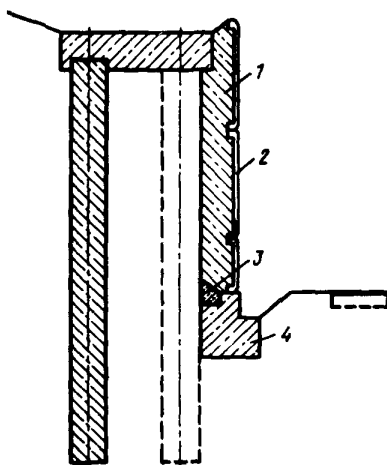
Конструкция "одевающей" стены верхнего поддерживающего сооружения: 1 - "одевающая" стена из монолитного бетона; 2 - сборные железобетонные плиты облицовки; 3 - застенный дренаж с выпусками; 4 - фундамент "одевающей" стены
